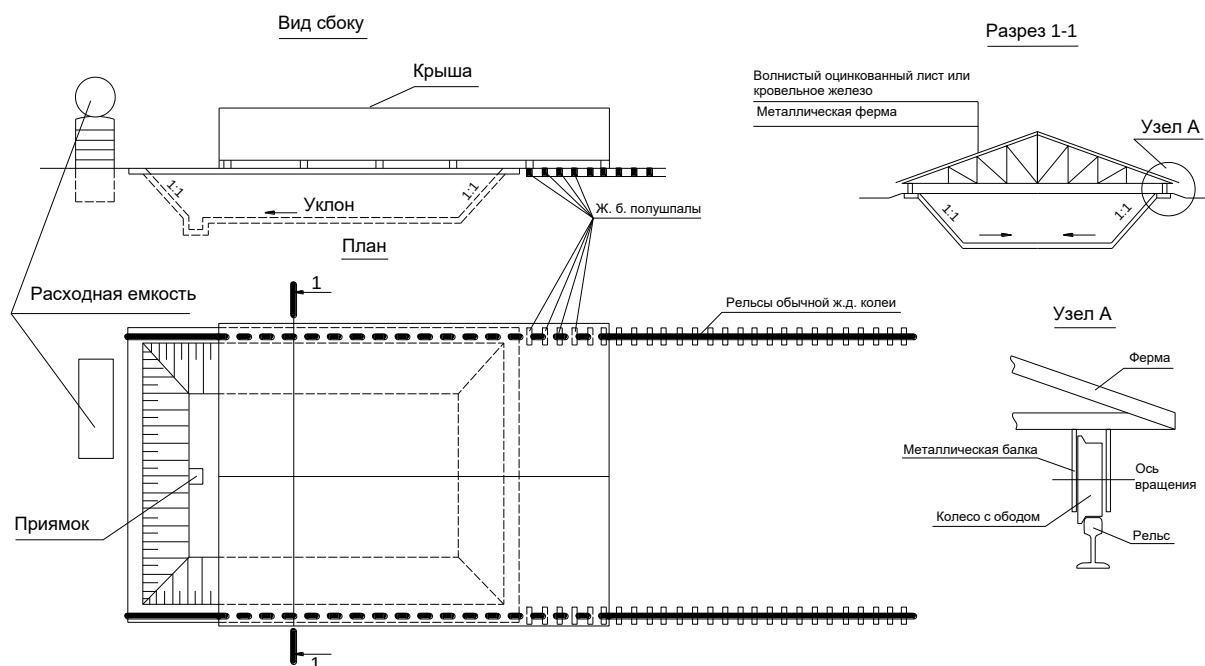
Схема хранилища для жидких ПГМ со сдвигаемой крышей
